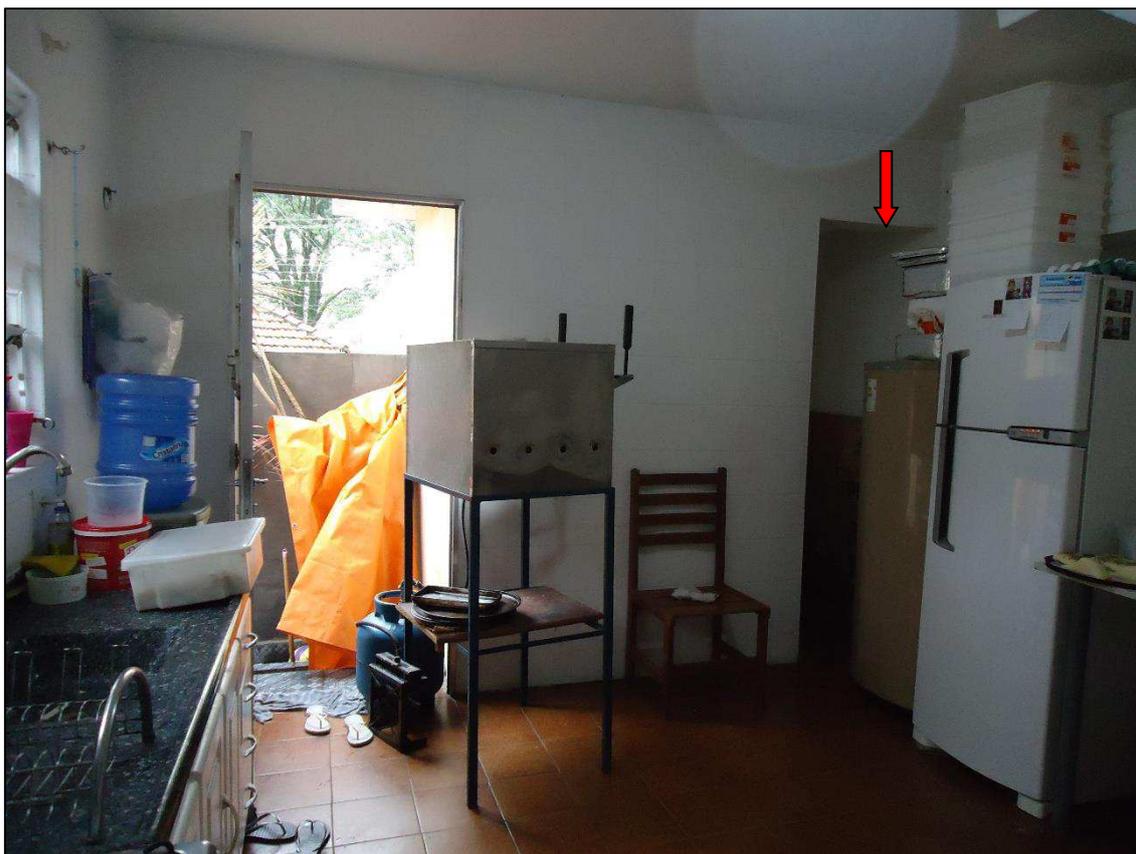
Vista da cozinha destacado acesso para área de serviço (lavanderia).
